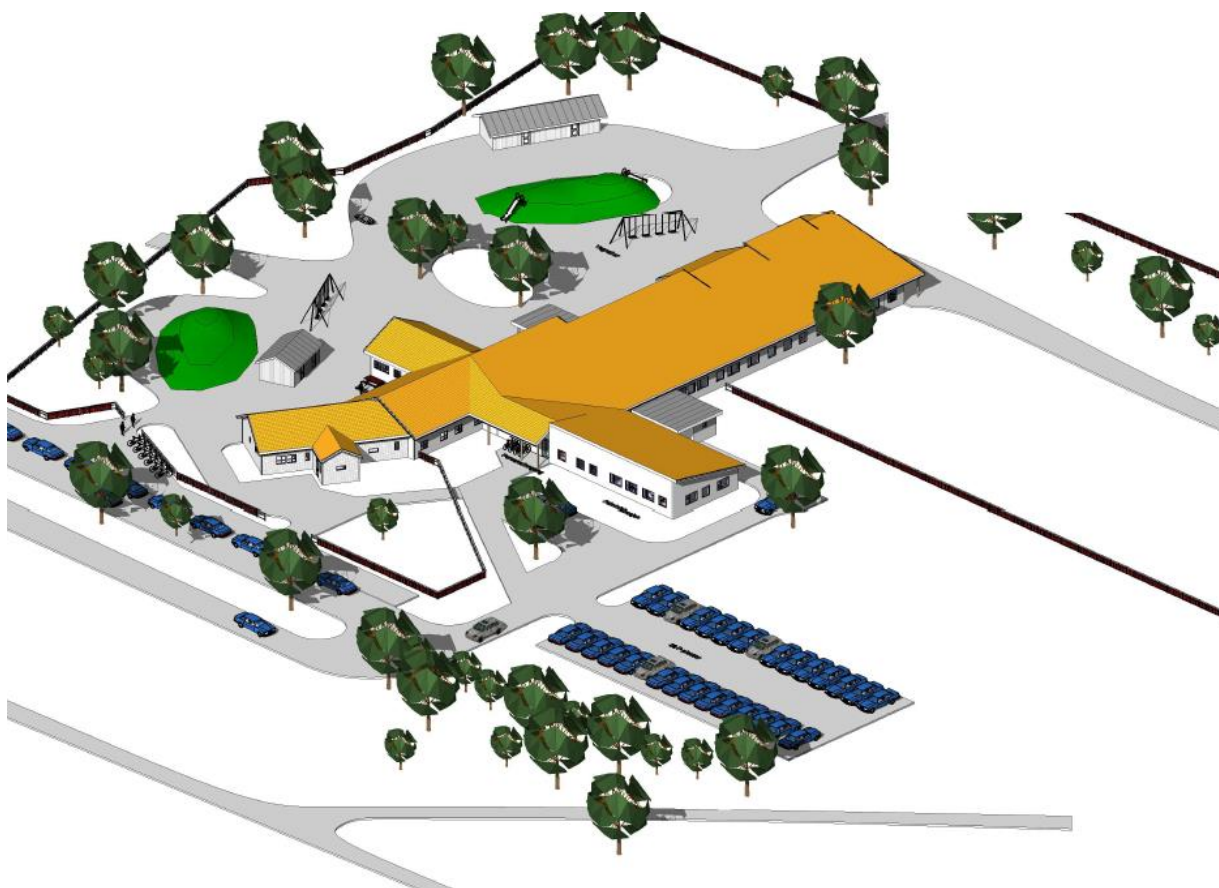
Hovedplan Høgegga barnehage 4 avdelinger
